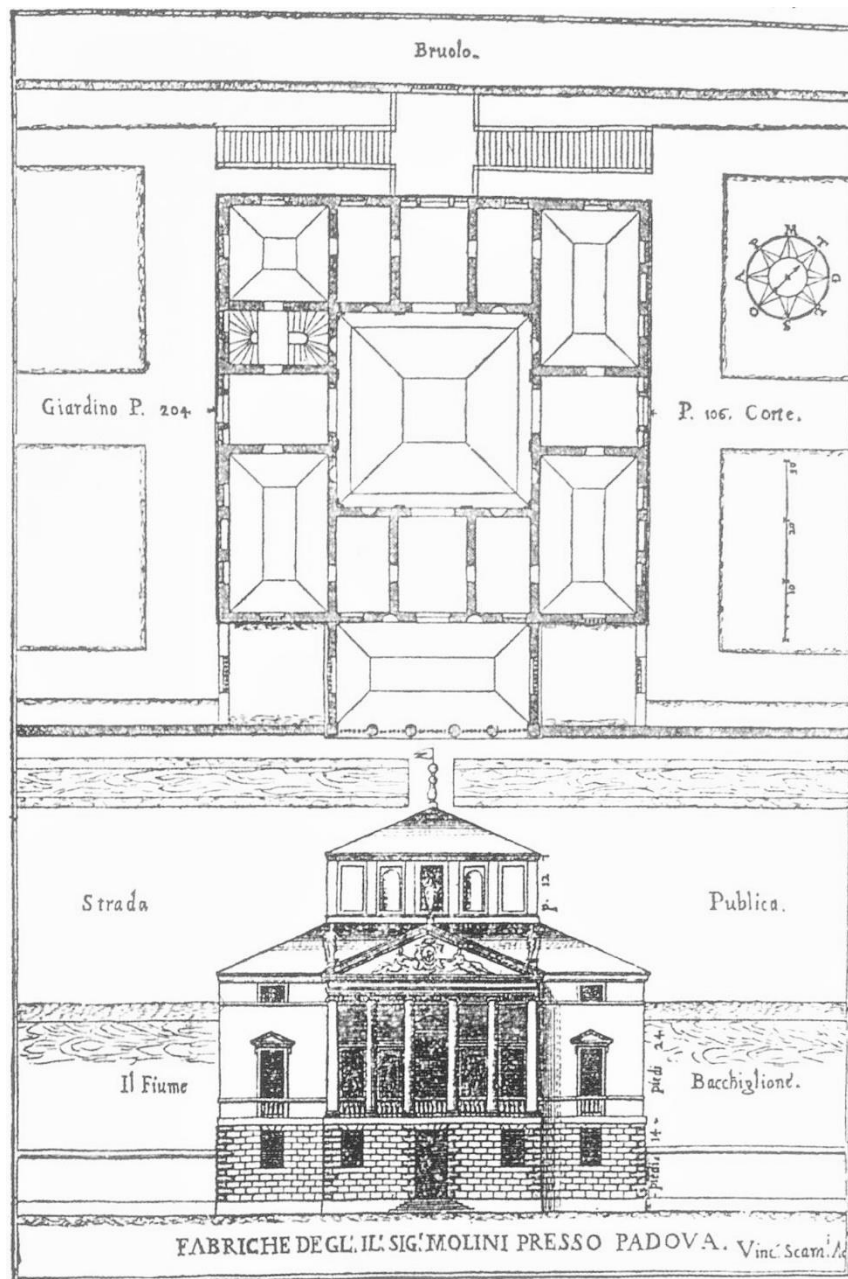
Vincenzo Scamozzi: *Villa Molin*, Grundriss, Hauptfassade, Mandria, 1597
